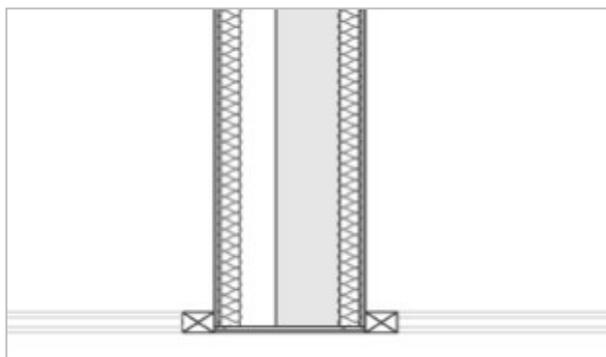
Raccordo parete vetrata e divisorio M12 – piano interrato – laboratori.
